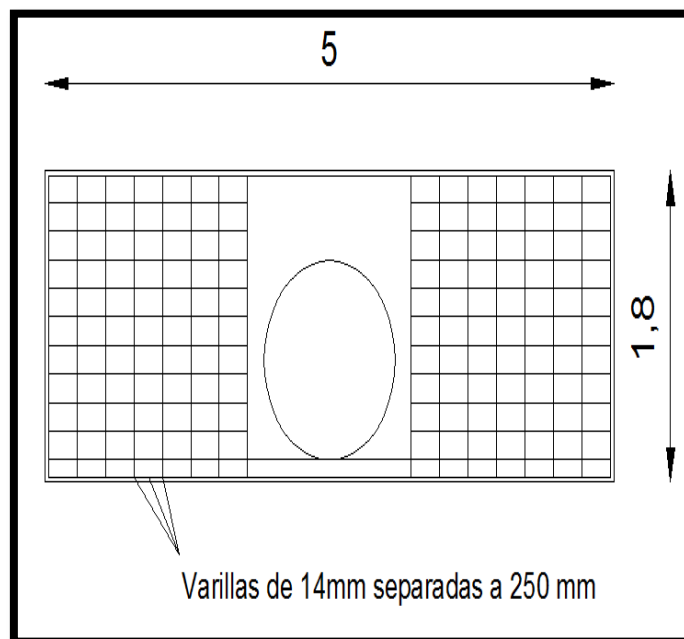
Elevación frontal del cabezal para alcantarillas de 1200mm.
